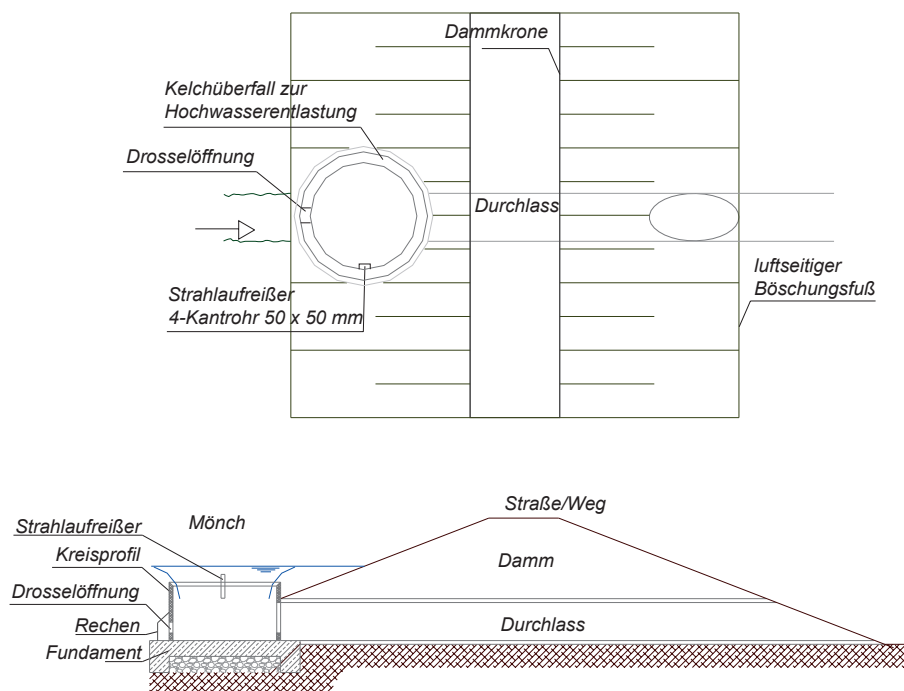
Kleinrückhalt durch Einstau eines vorhandenen Straßen- oder Wegedamms (mit Mönchbauwerk zur Drosselung des Durchlasses und zur Notentlastung)
